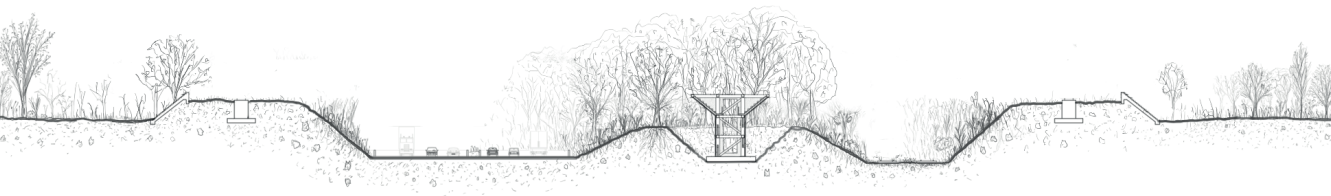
Remblais sur les fondations aux extrémités et mise en place de l'appui intermédiaire
